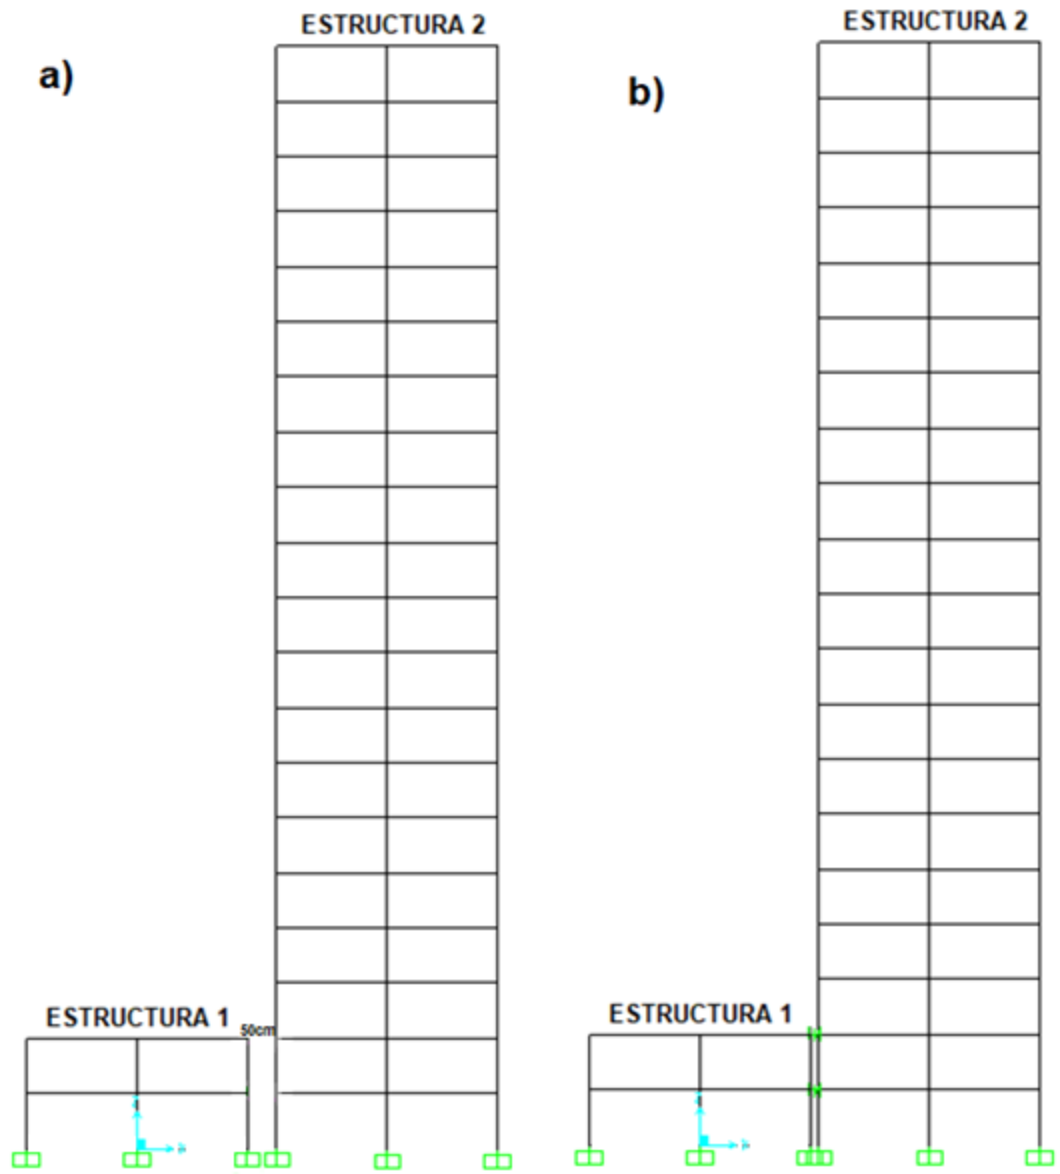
Modelo 10. a) Estructuras aisladas b) Estructuras adosadas
